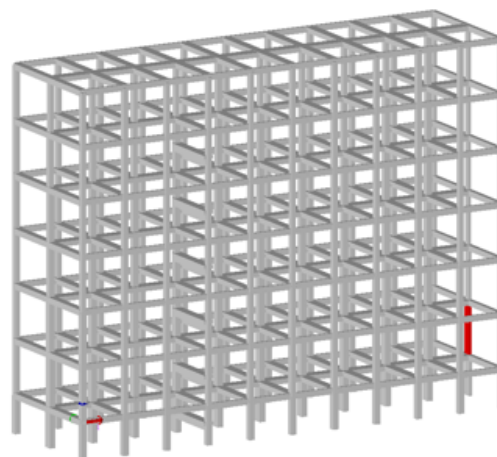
Modello US B1 - PROSAP, Archivio Sezioni, Proprietà n° 8 Pilastro di giunto 25 x 70, con inquadramento.
